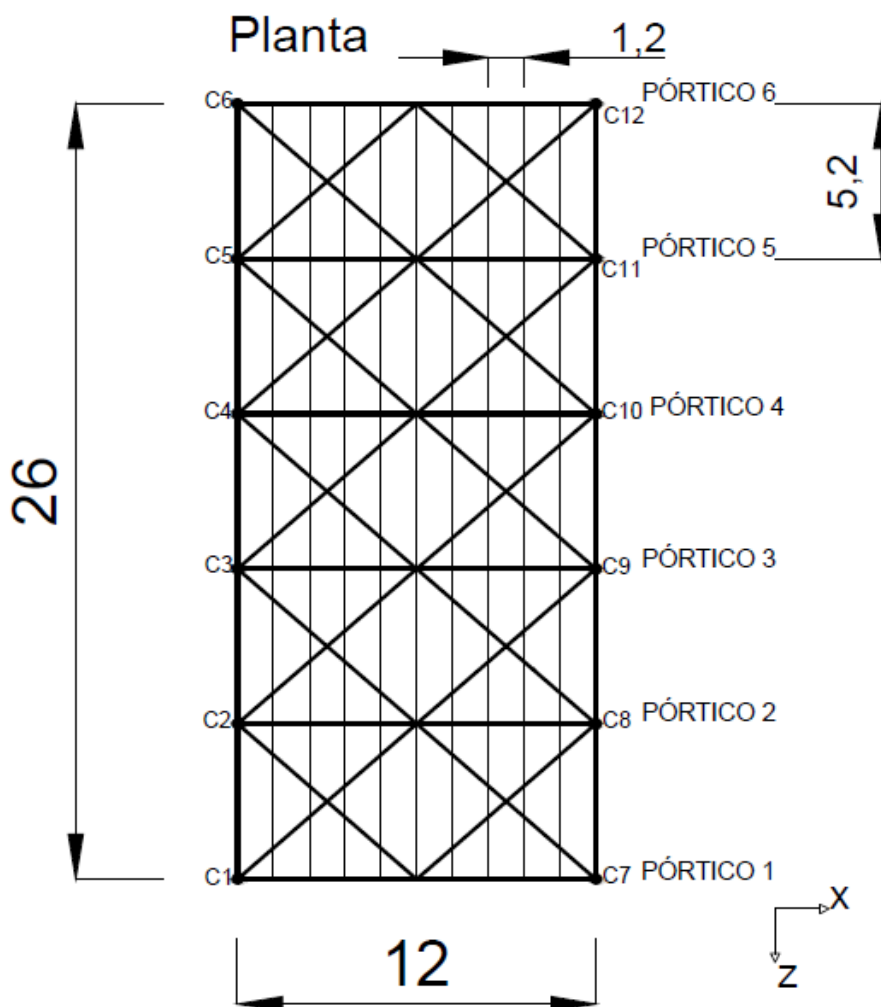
Vista en planta de la estructura con las referencias de sus pórticos.
